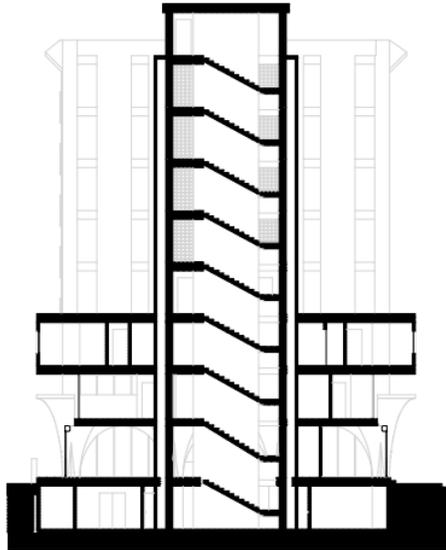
Sección transversal actual. Fuente: Tesistas.
